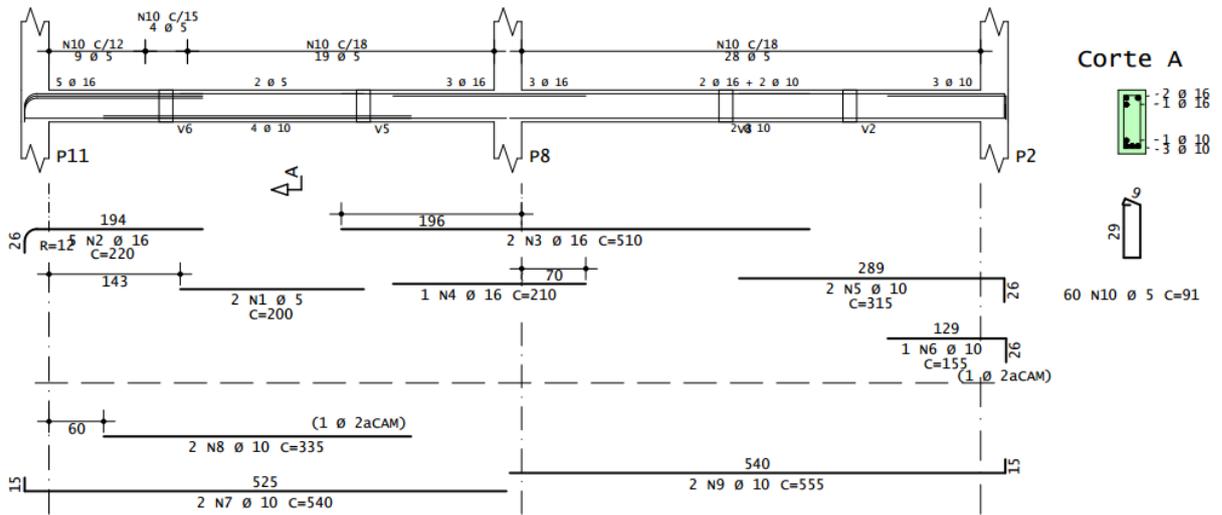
Armadura da viga baldrame V11 – pavimento térreo (nível 0,00)
